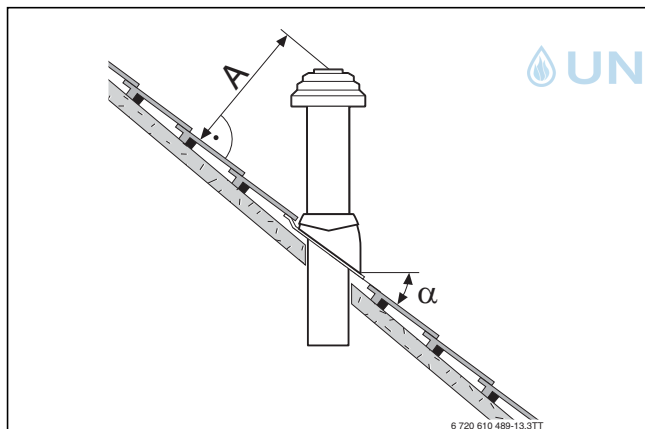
Abstandsmaße und Dachneigungen bei Schrägdach
